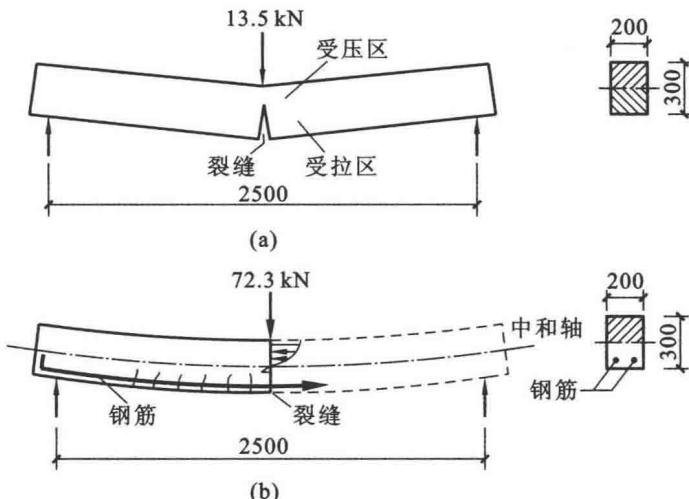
素混凝土及鋼筋混凝土簡支梁的承載力
